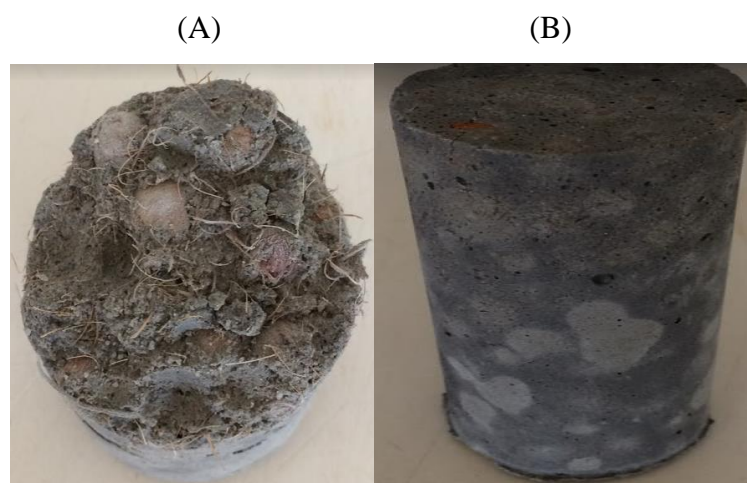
(A) Desmoldagem após 24 h, (B) desmoldagem após 1 semana.
